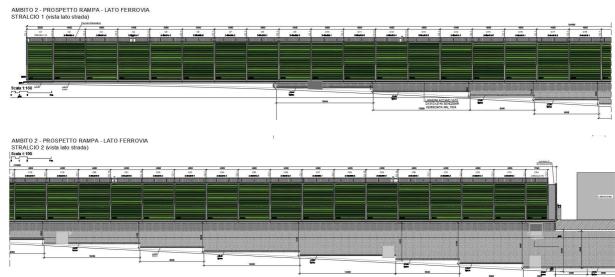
Prospetto della barriera dell'ambito 2 - lato ferrovia
